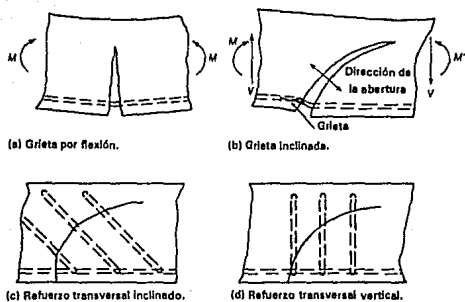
Agrietamiento Inclinado y refuerzo transversal (Ref. 3)
